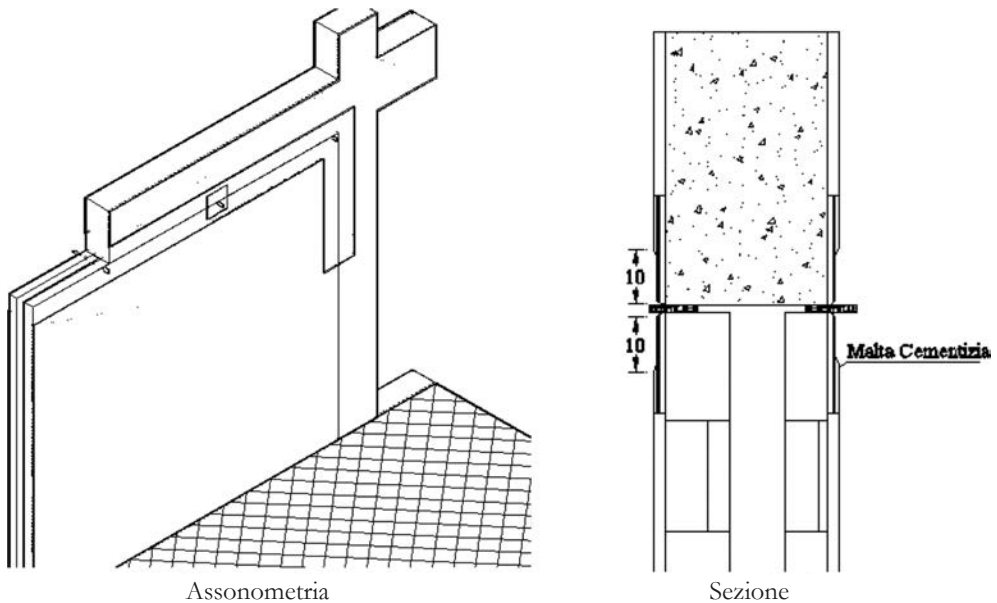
Applicazione di un secondo strato di malta cementizia bicomponente ad elevata duttilità.
